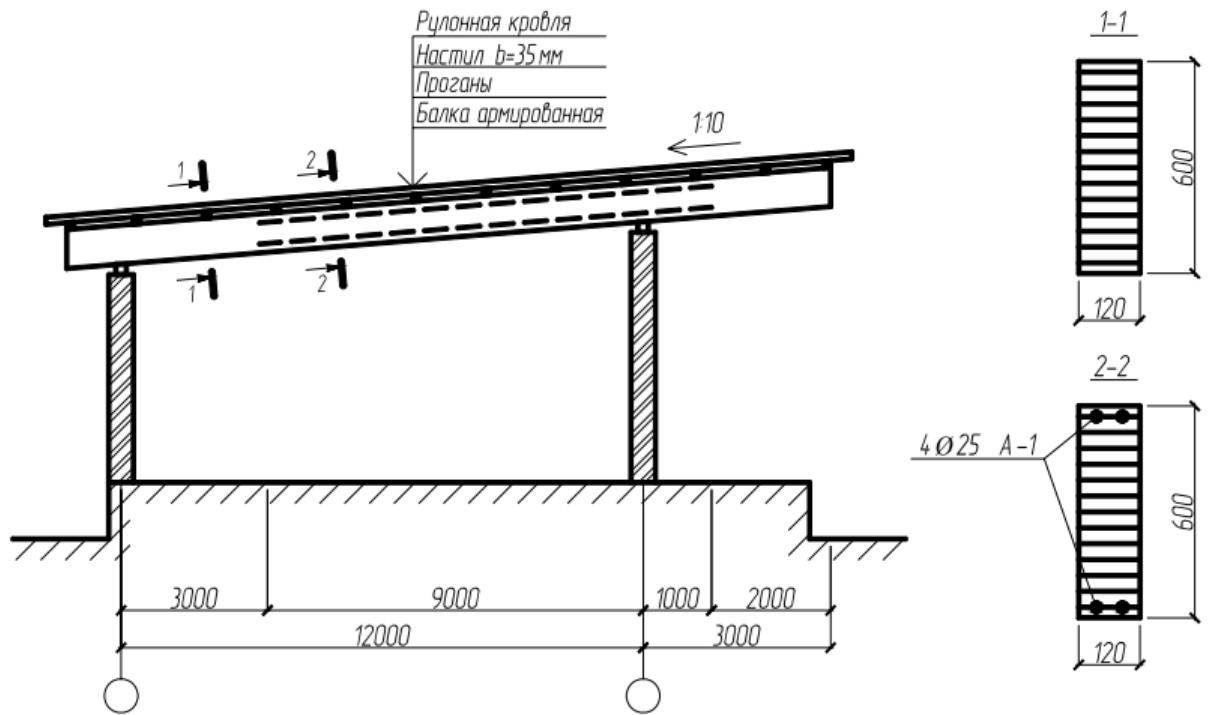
Клееные армированные балки переменной жесткости в покрытии складского здания (г. Владимир)
